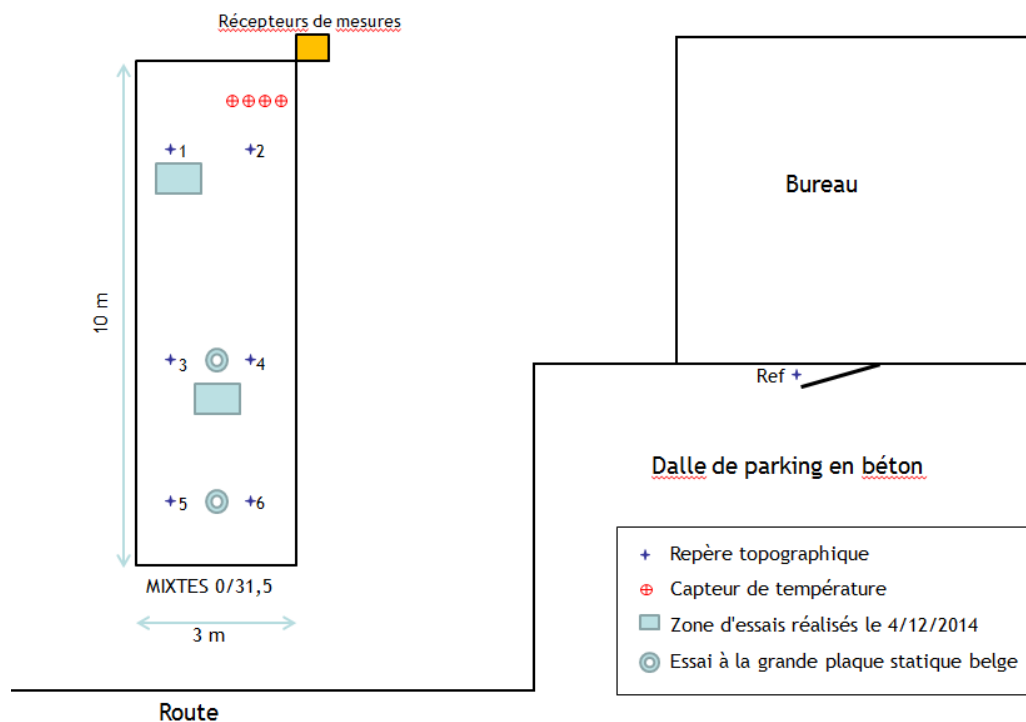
Implantation de la planche d'essais et des différents points de mesure.
